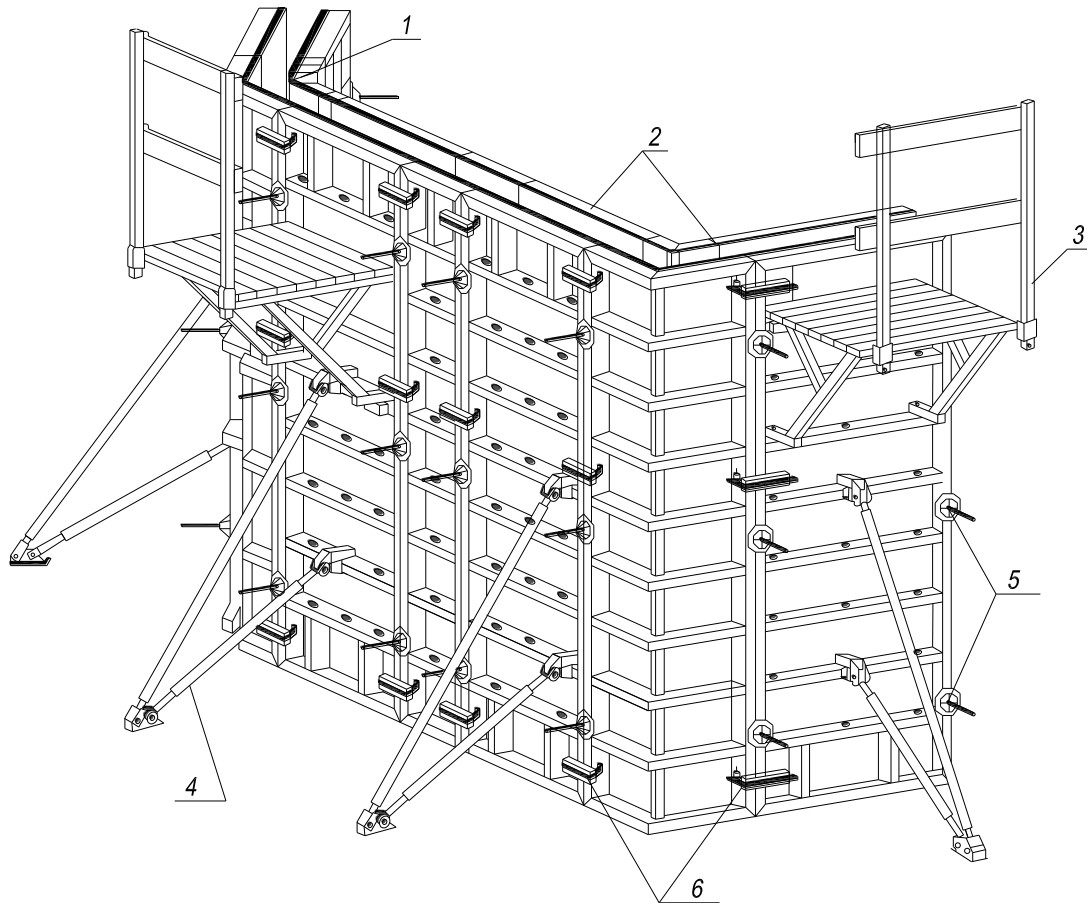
Фрагмент установки великощитової опалубки для бетонування стін
